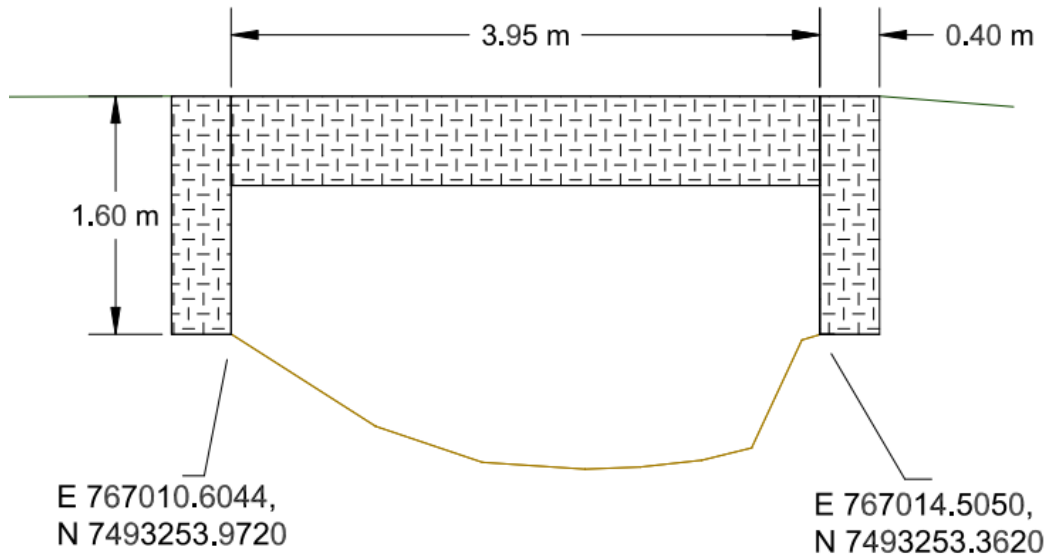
Ponte 7 levantada no Valão da Caixa. Coordenadas da vista de montante em projeção UTM sistema de referência SIRGAS 2000.
